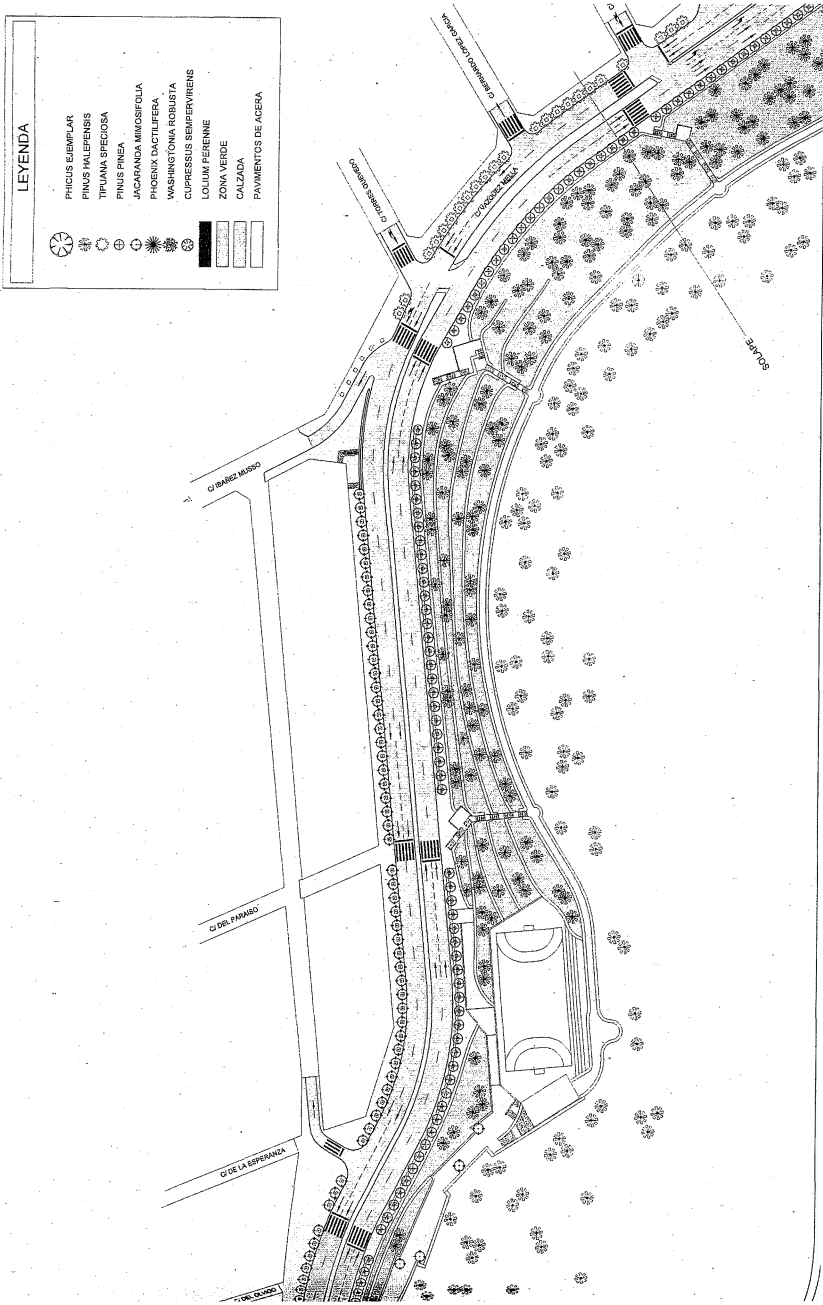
Planta trazado (aspecto final). Ayuntamiento de Alicante.
